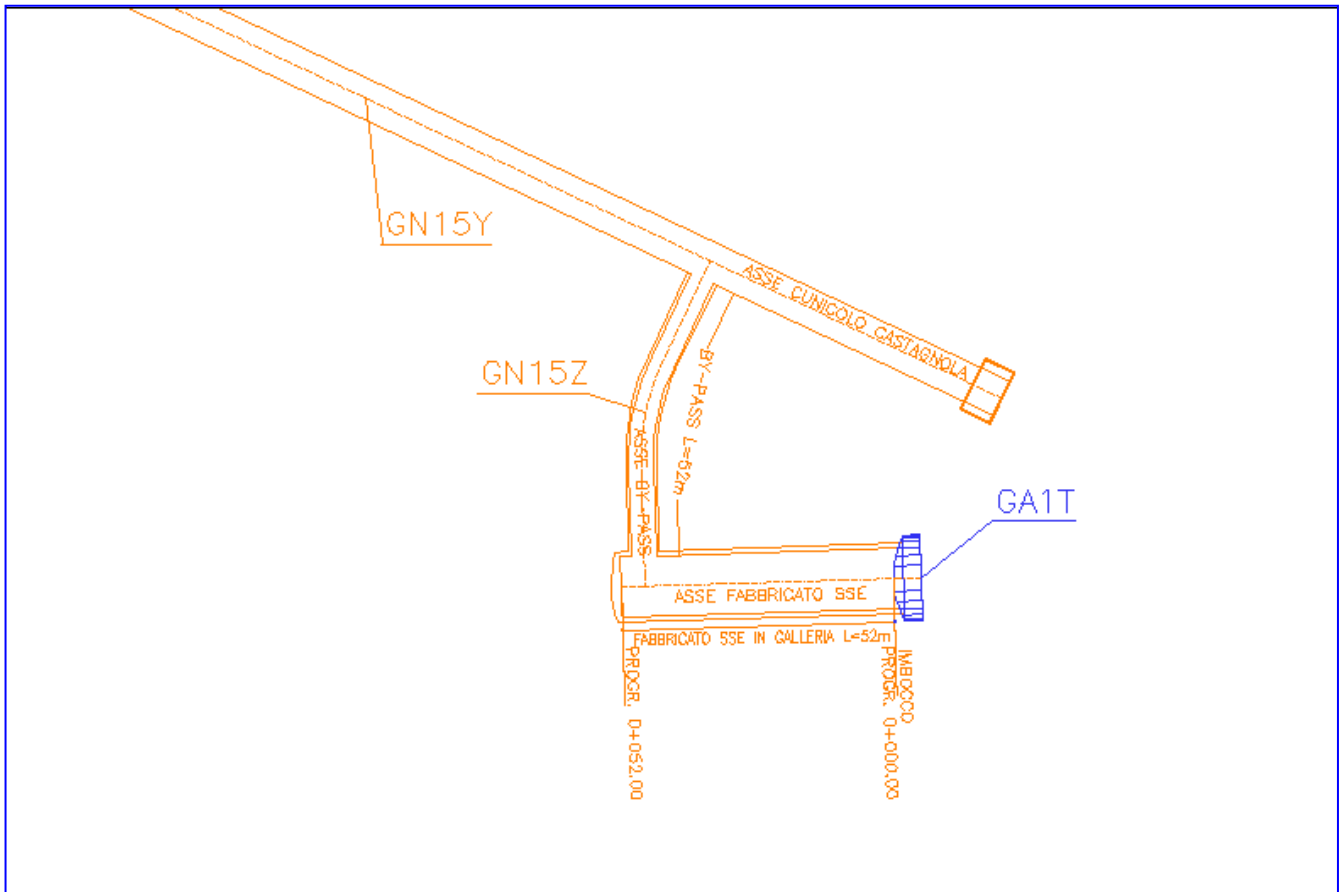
WBS GA1T – Planimetria della tratta evidenziata in blu
